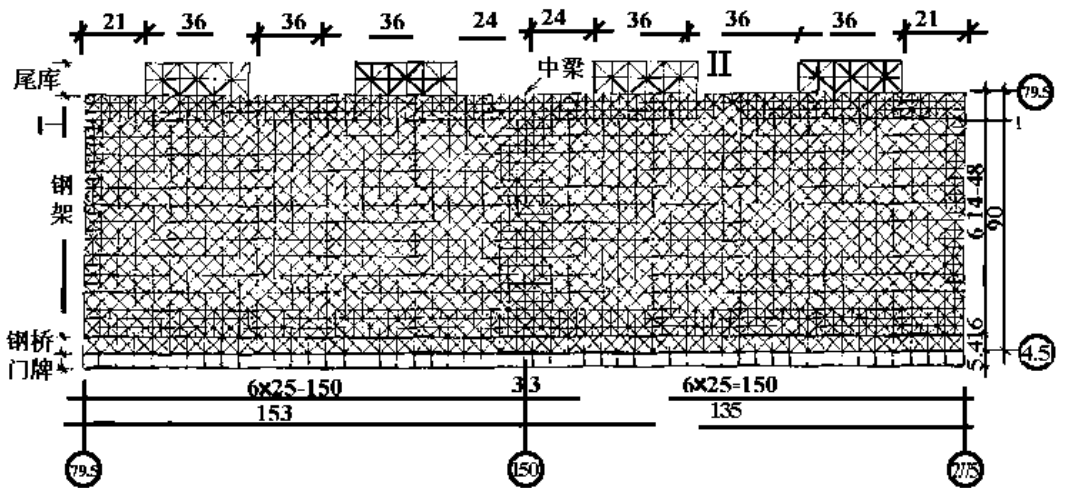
飞机库钢屋盖平面图 (单位: m)
